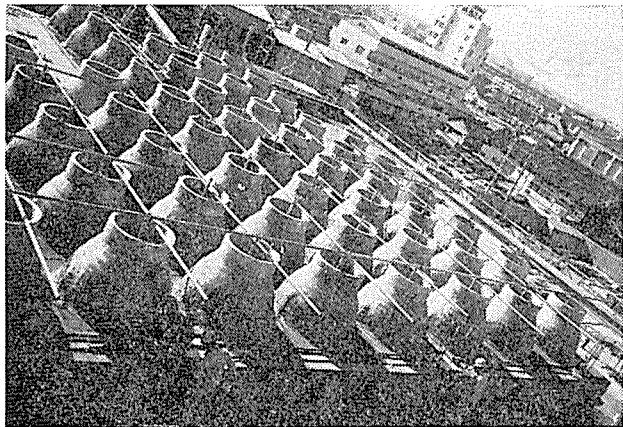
こども館のトップライト用 GRC 型枠を布設している状況
